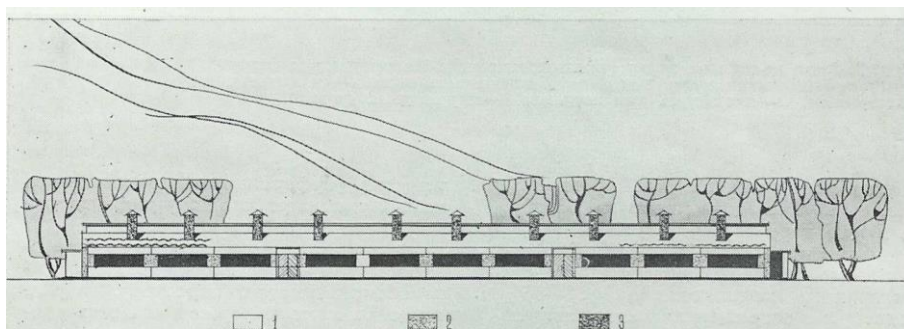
Фасад животноводческого здания на 150 свиноматок:
